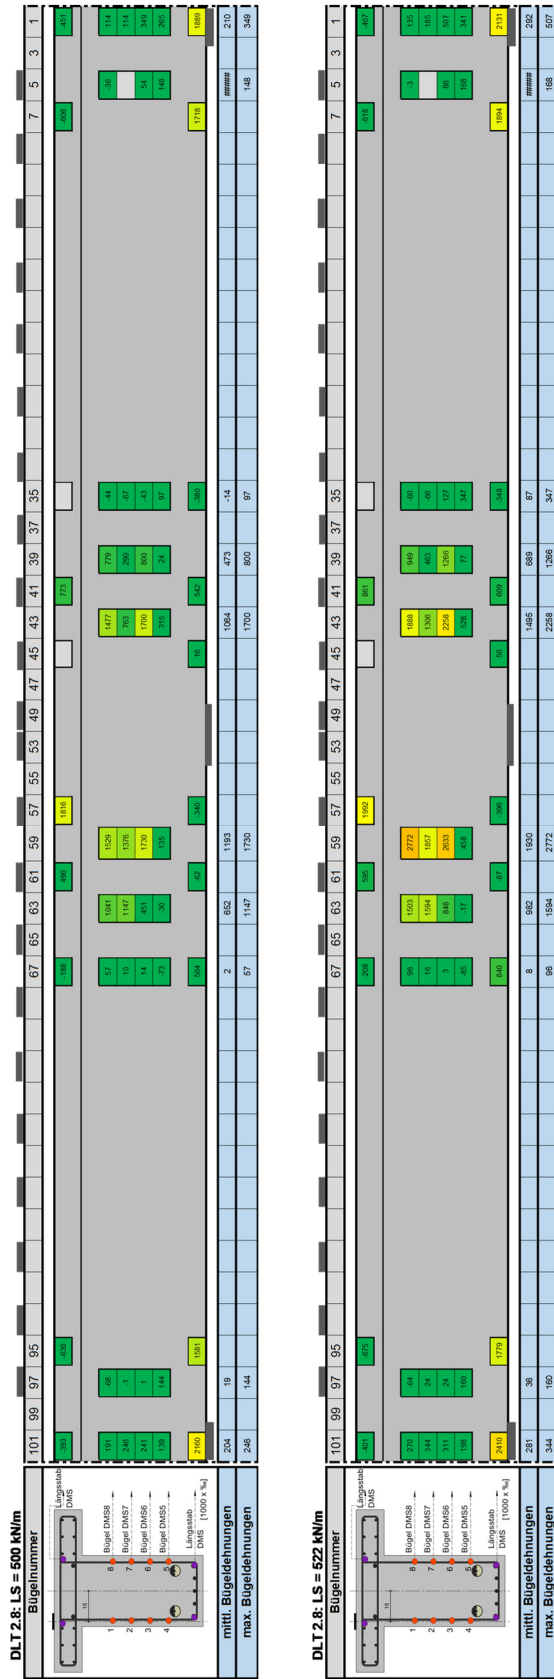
Betonstahldehnungen des Versuchsträgers DLT 8 für ausgewählte Laststufen – Rückseite, Teil 1
